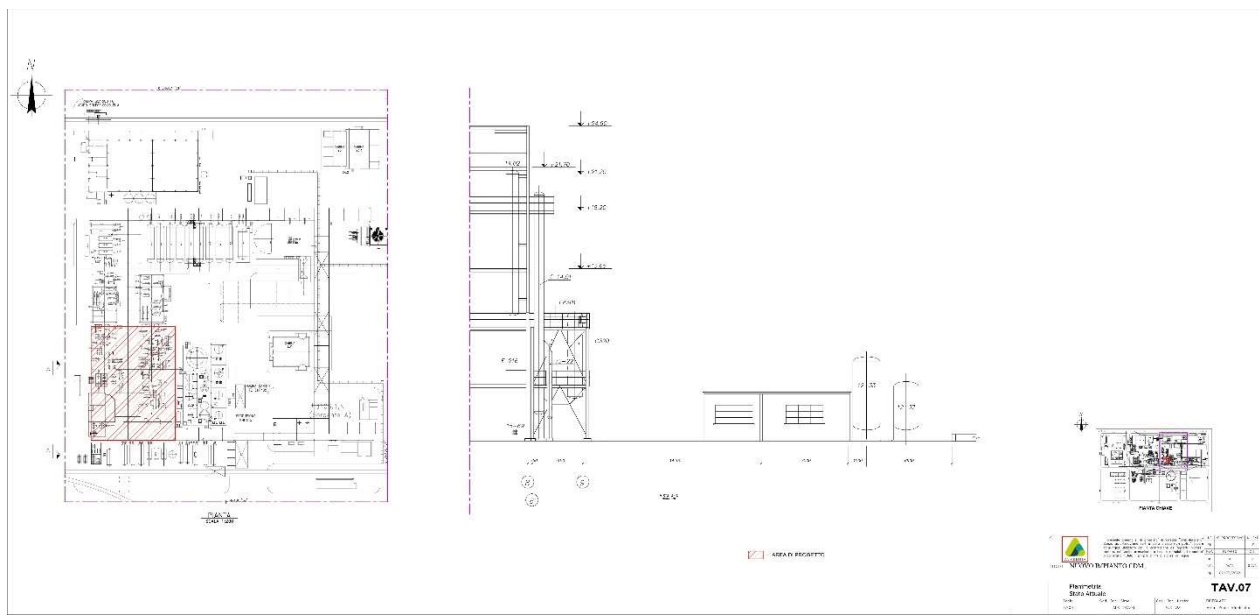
All. G09 -Tav07 STATO ATTUALE IMP
